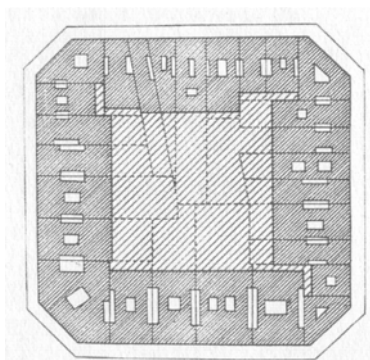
Planta tipo del Ensanche de Barcelona, ordenanza de 1891. Fuente:.
